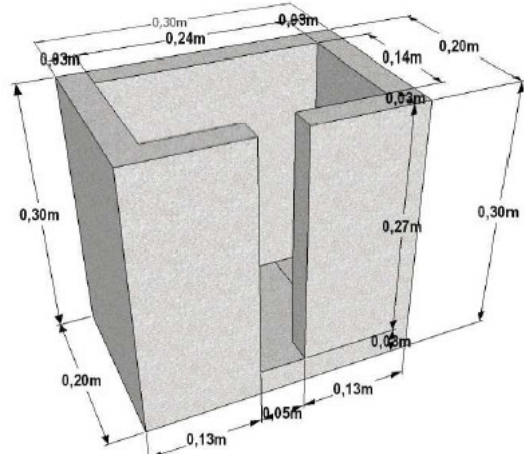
Croqui esquemático das dimensões do bloco tipo caixa grande (CG)
